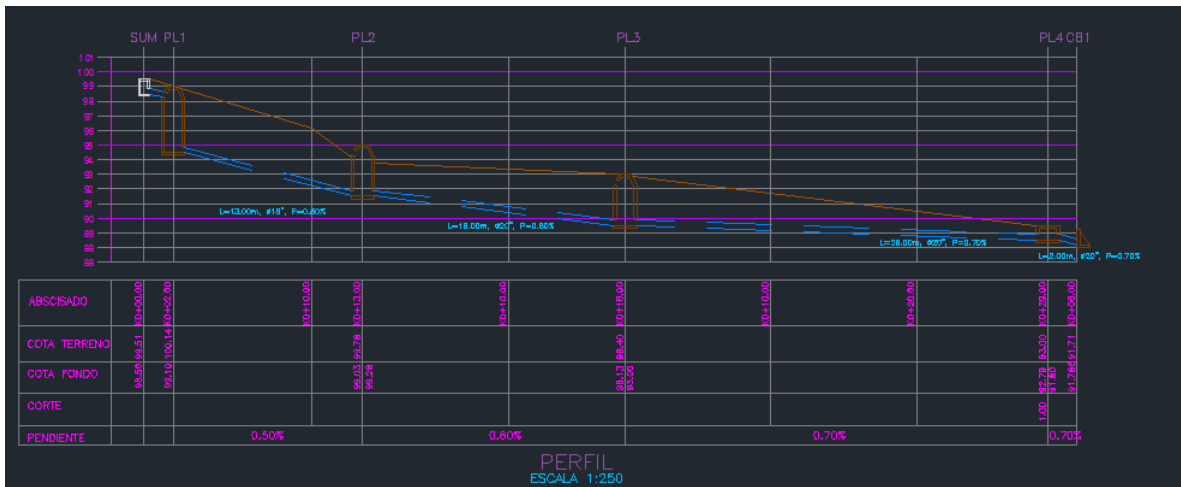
Captura plano Autocad vista en perfil diseños constructivos. Barrio Bosques de la cira
